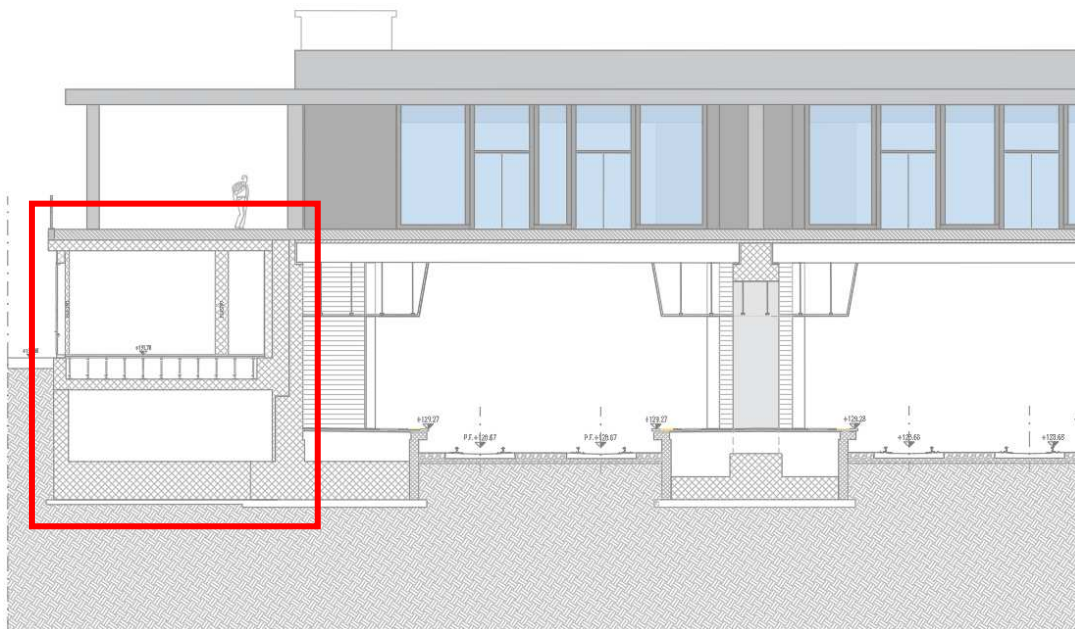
Sezione fabbricato di stazione con Cabina di stazione.
